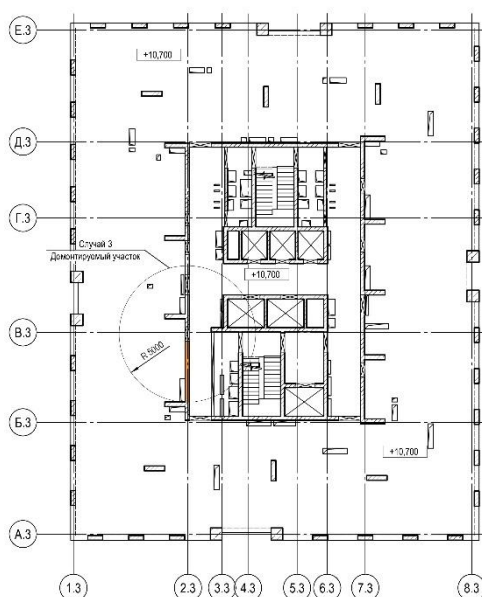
Корпус К-3. Схема аварийного случая 3
